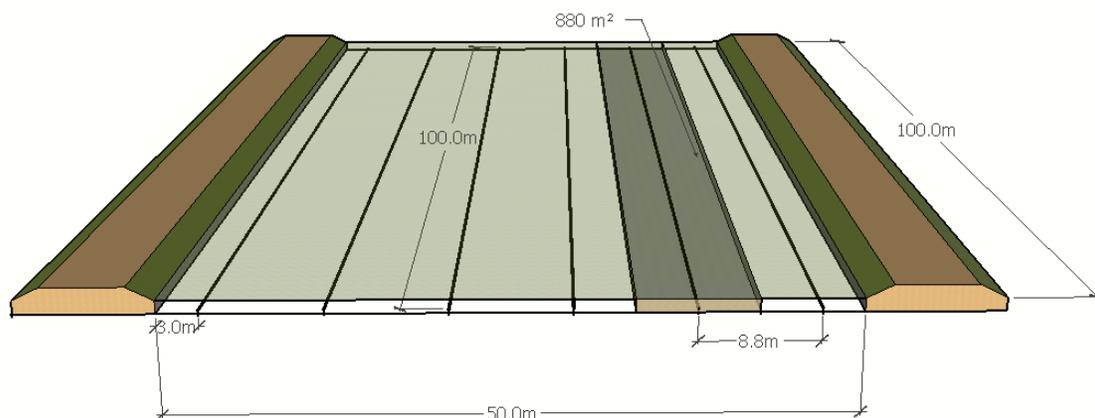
Champ Y : Exemple de la superficie drainée par drain dans un champ de 100m x 50 m, drainé unilatéralement par six drains drainant sur toute la longueur
